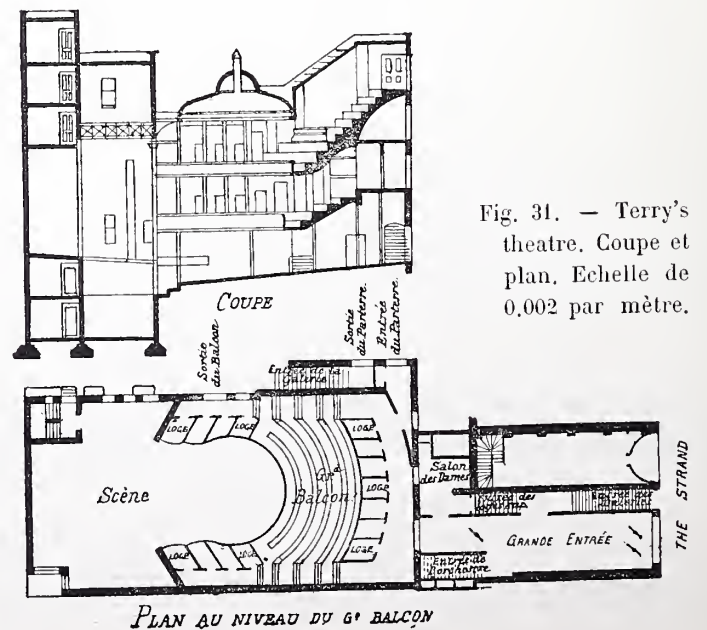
Terry's theatre, Coupe et plan. Echelle de 0,002 par mètre.
